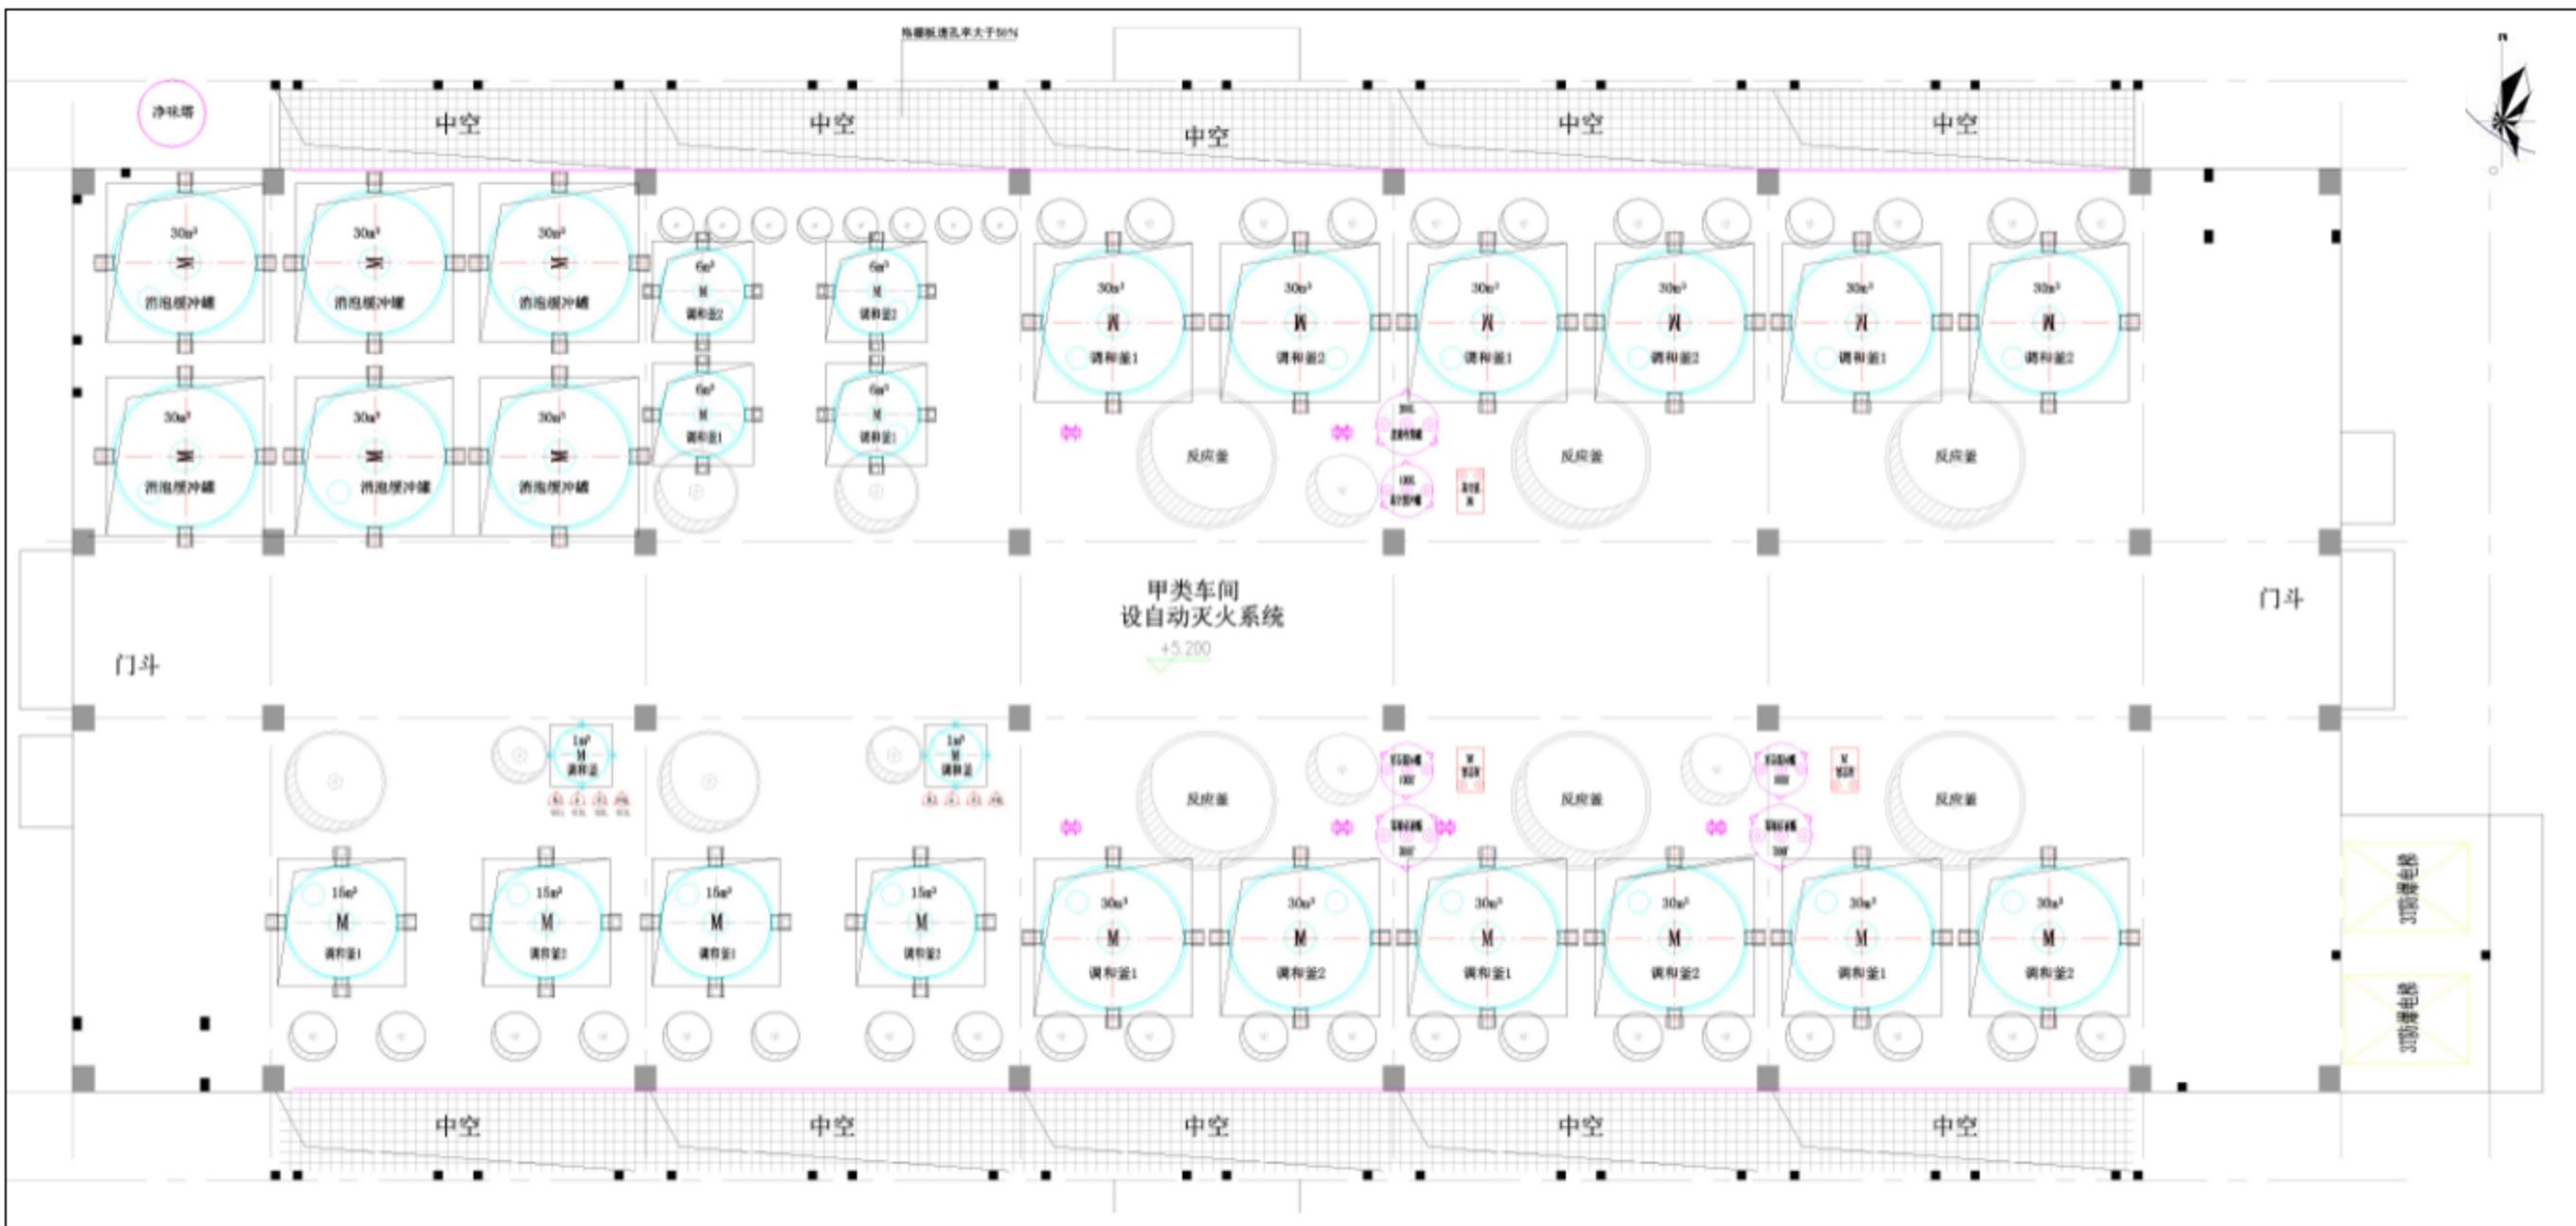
甲类车间B2层平面布置图（比例尺1:100）
